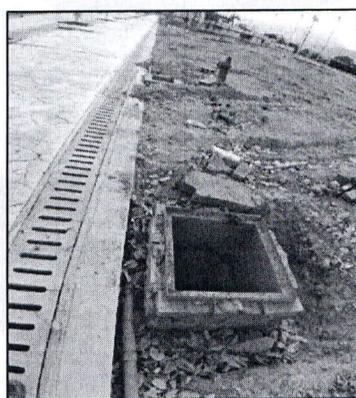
falta instalar tapas de hidrantes P punto de riego y bebedero P.27
